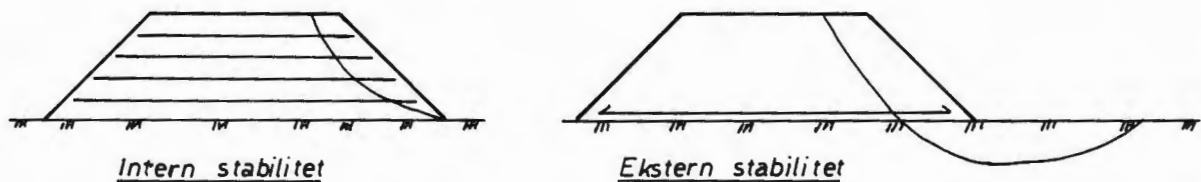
Støttekonstruksjon / fyllingskråning.
